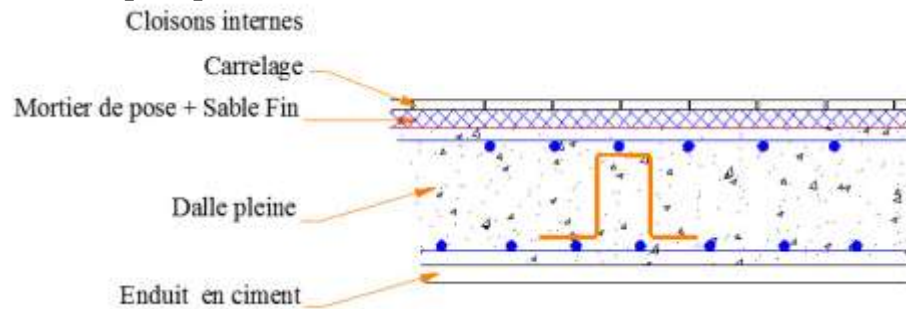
Coupe verticale de Palier de repos (Dalle pleine)
